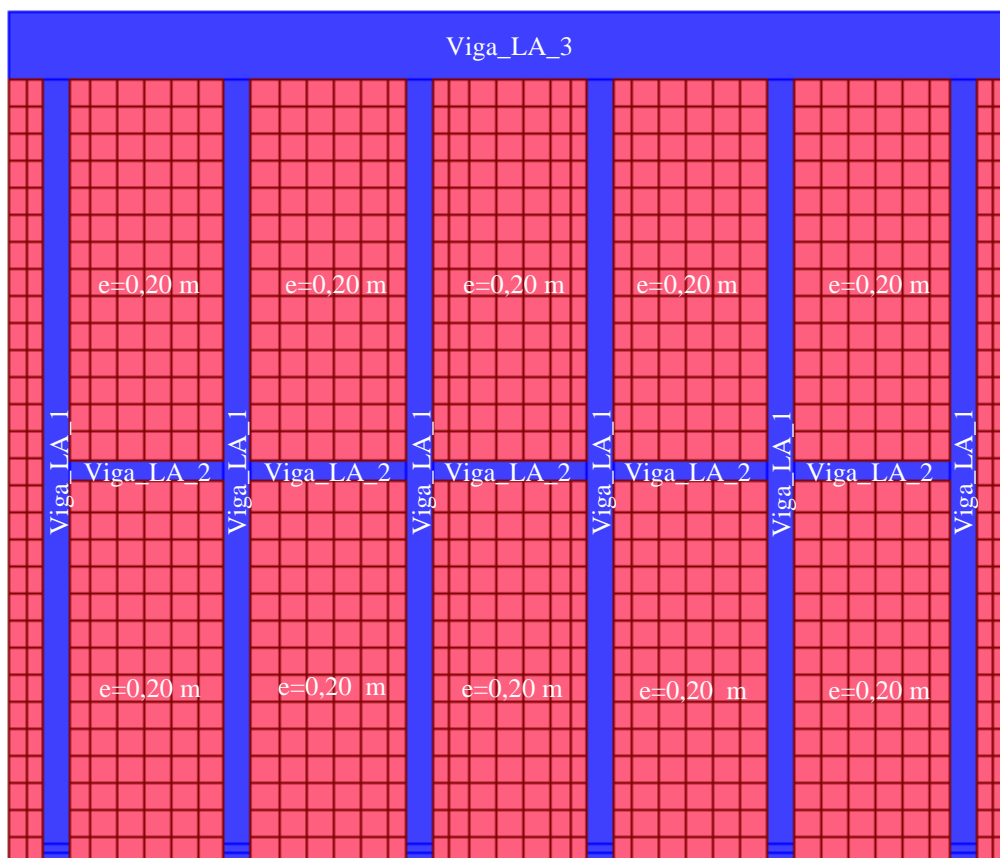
Identificação do conjunto das lajes e identificação das vigas da laje de acesso
